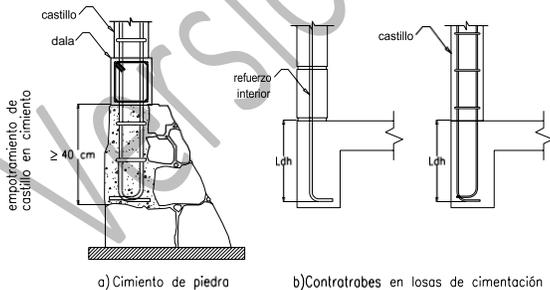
Anclaje del refuerzo vertical en cimientos
